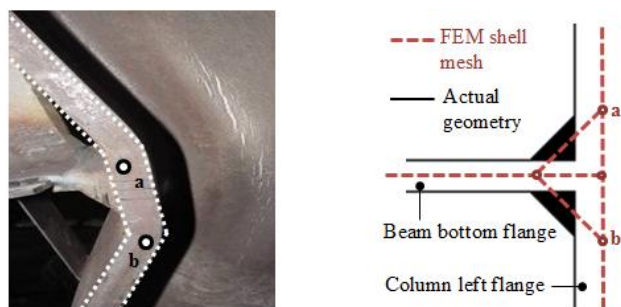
Representação da Projecção da espessura da soldadura [Jordão, 2008]
